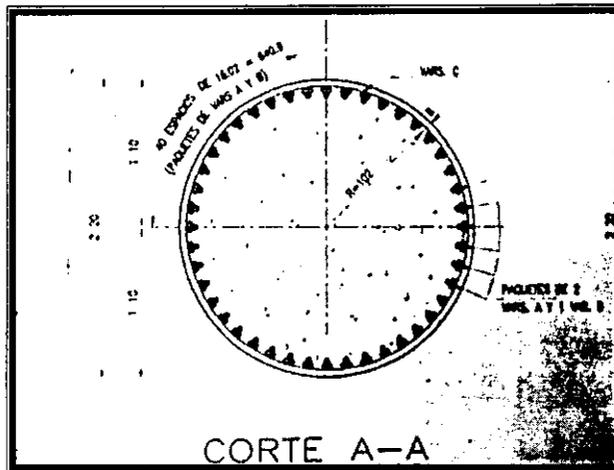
Pila circular de 2.20 m de diámetro y armado en su sección inferior.
